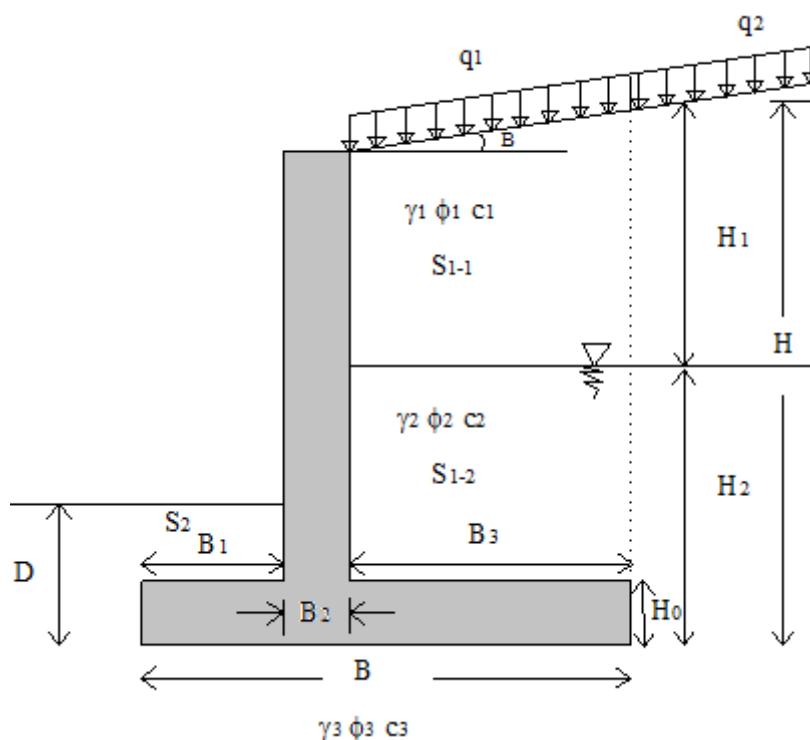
Dimensions usuelles d'un mur de soutènement en béton armé.
